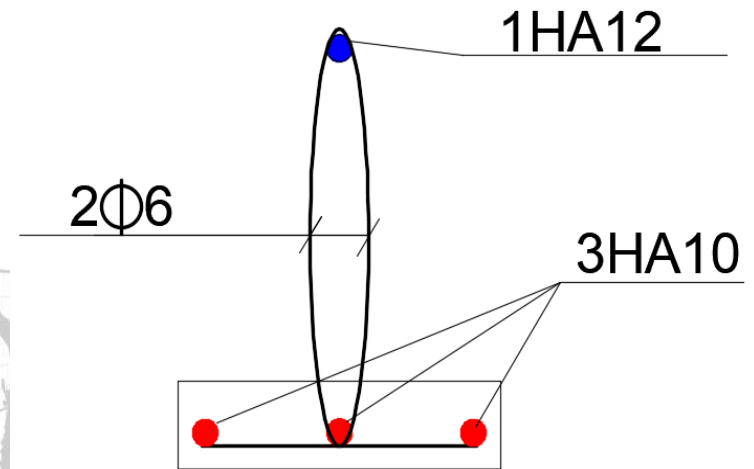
Ferrailage du plancher Etages courants.
